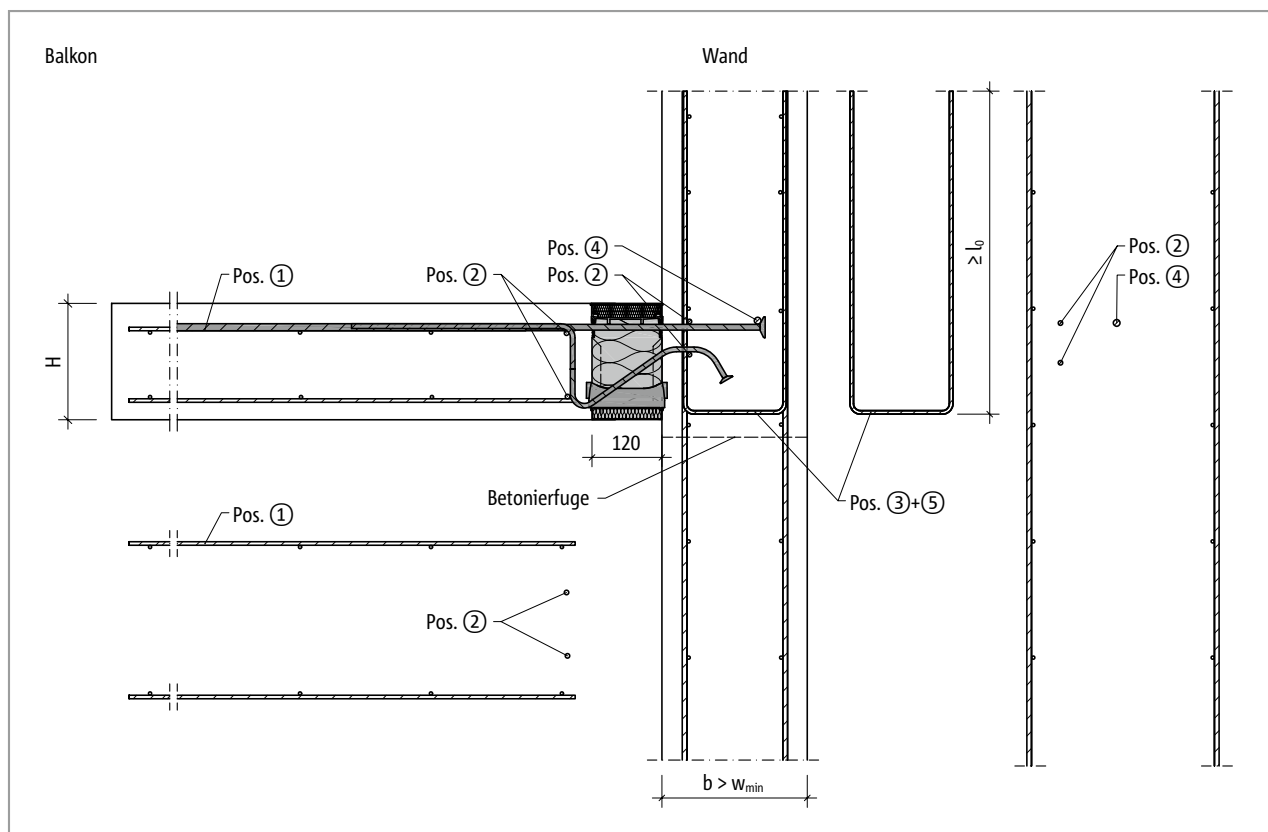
Schöck Isokorb® XT Typ K-U: Bauseitige Bewehrung für Wandanschluss nach oben mit größerer Bauteilabmessung ( $w_{vorh} > w_{min}$ )
